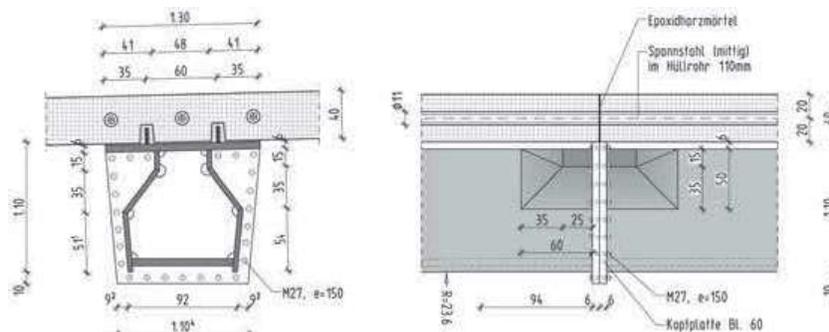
Details Stahlkonstruktion Überbau und Detail zur Injizierten Fuge
